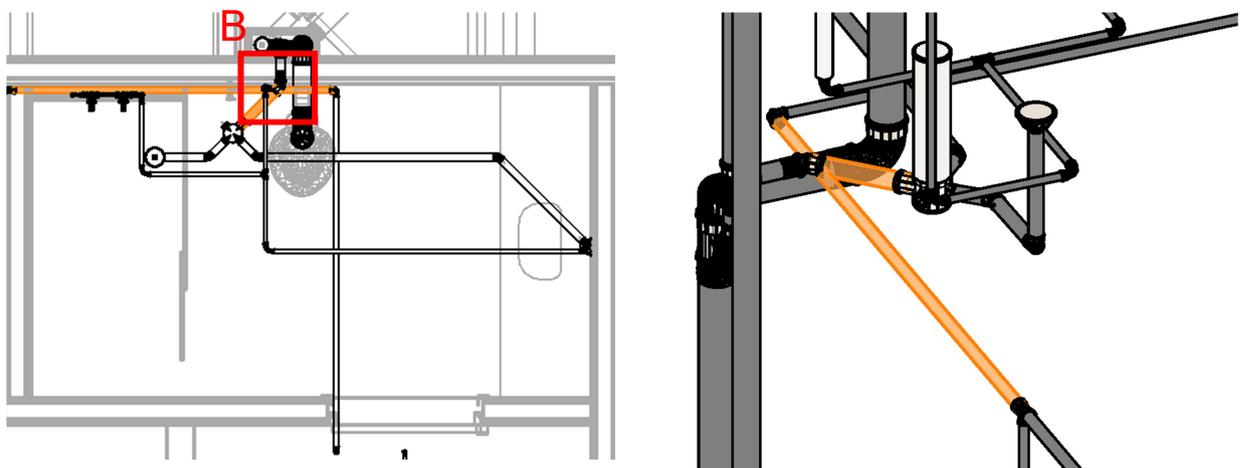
Planta baixa do pavimento superior hidráulico com o sanitário
